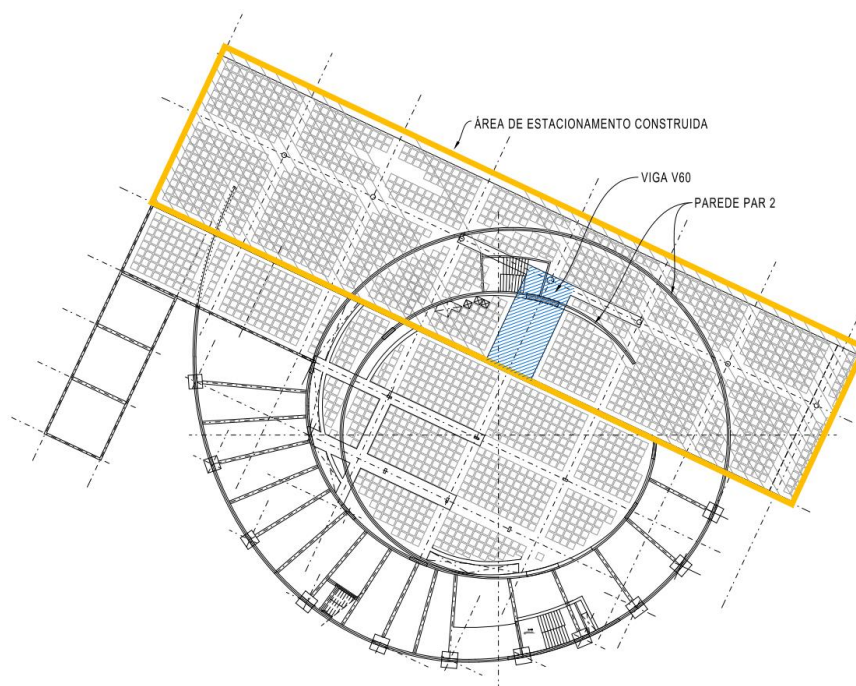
Planta do piso térreo do edifício, com ilustração das diferentes situações de apoio das paredes.
